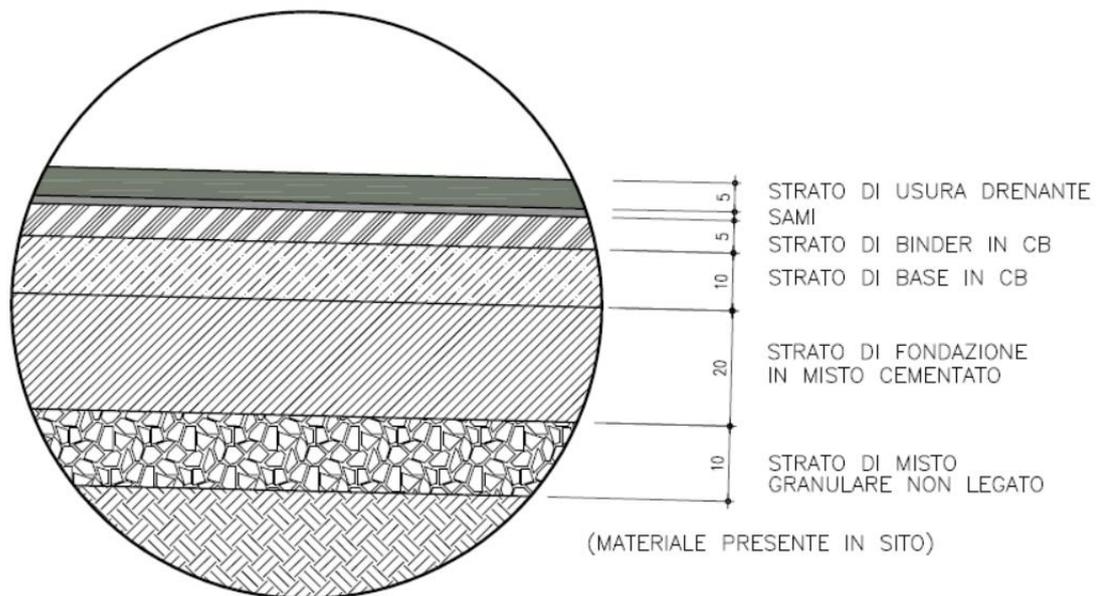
Sezione pavimentazione dell'asse principale e corsie dedicate
